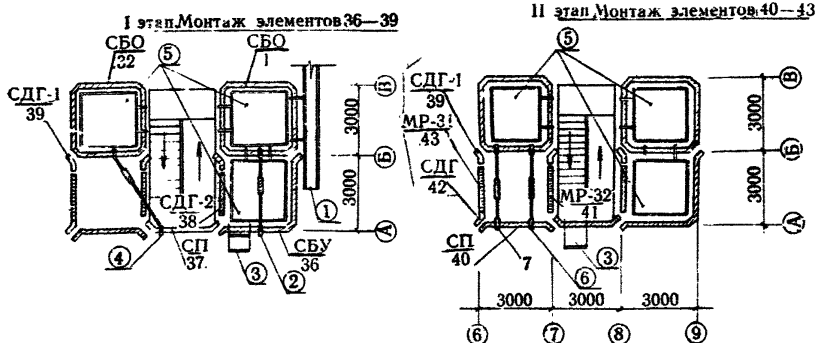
Схема последовательности монтажа элементов стен рабочего здания РЭС 4х175 (пример 5 ряда)
